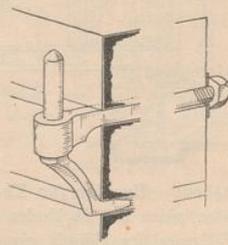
Beschlag. Stützhaken mit Schraube für Backsteinmauerwerk.
